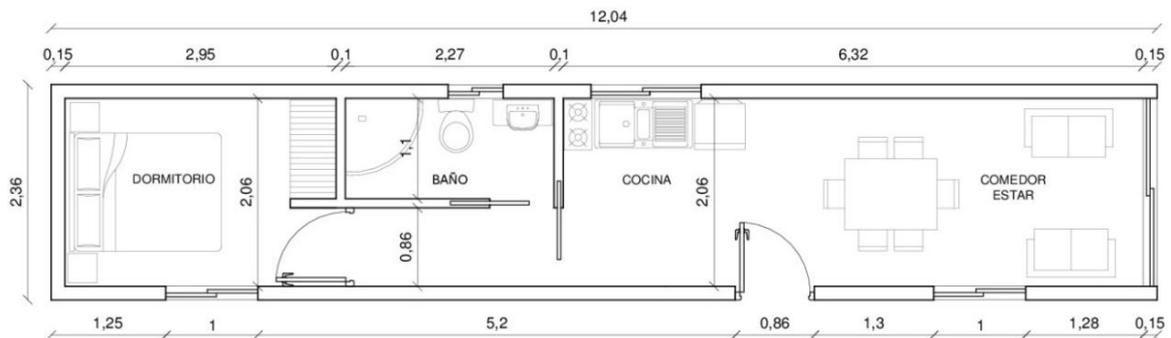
Plano vivienda tipo cabaña. Fuente: Propia
